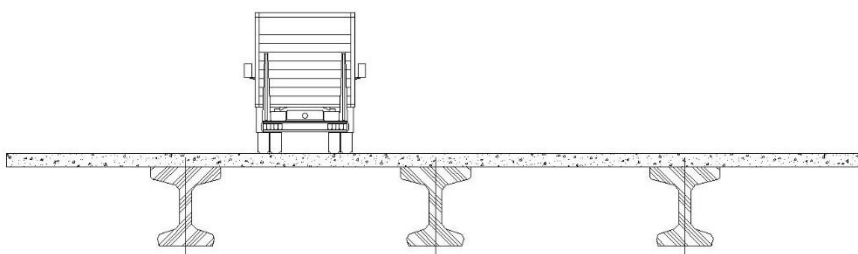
Posição de um veículo em relação a vigas longitudinais
